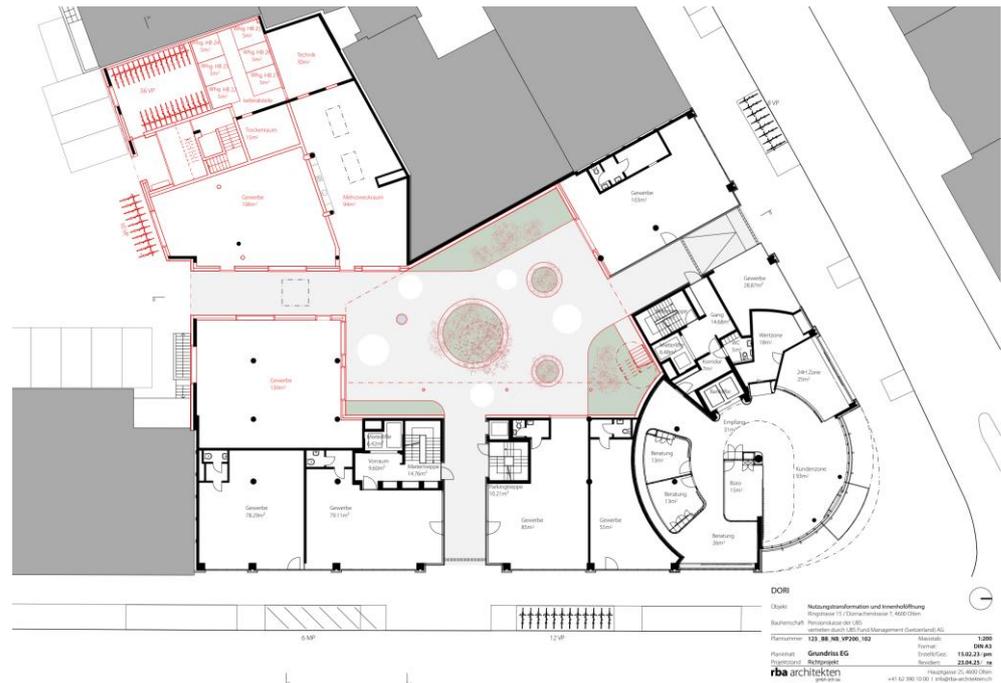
Grundriss Erdgeschoss (rba architekten gmbh eth sia, 2023)
